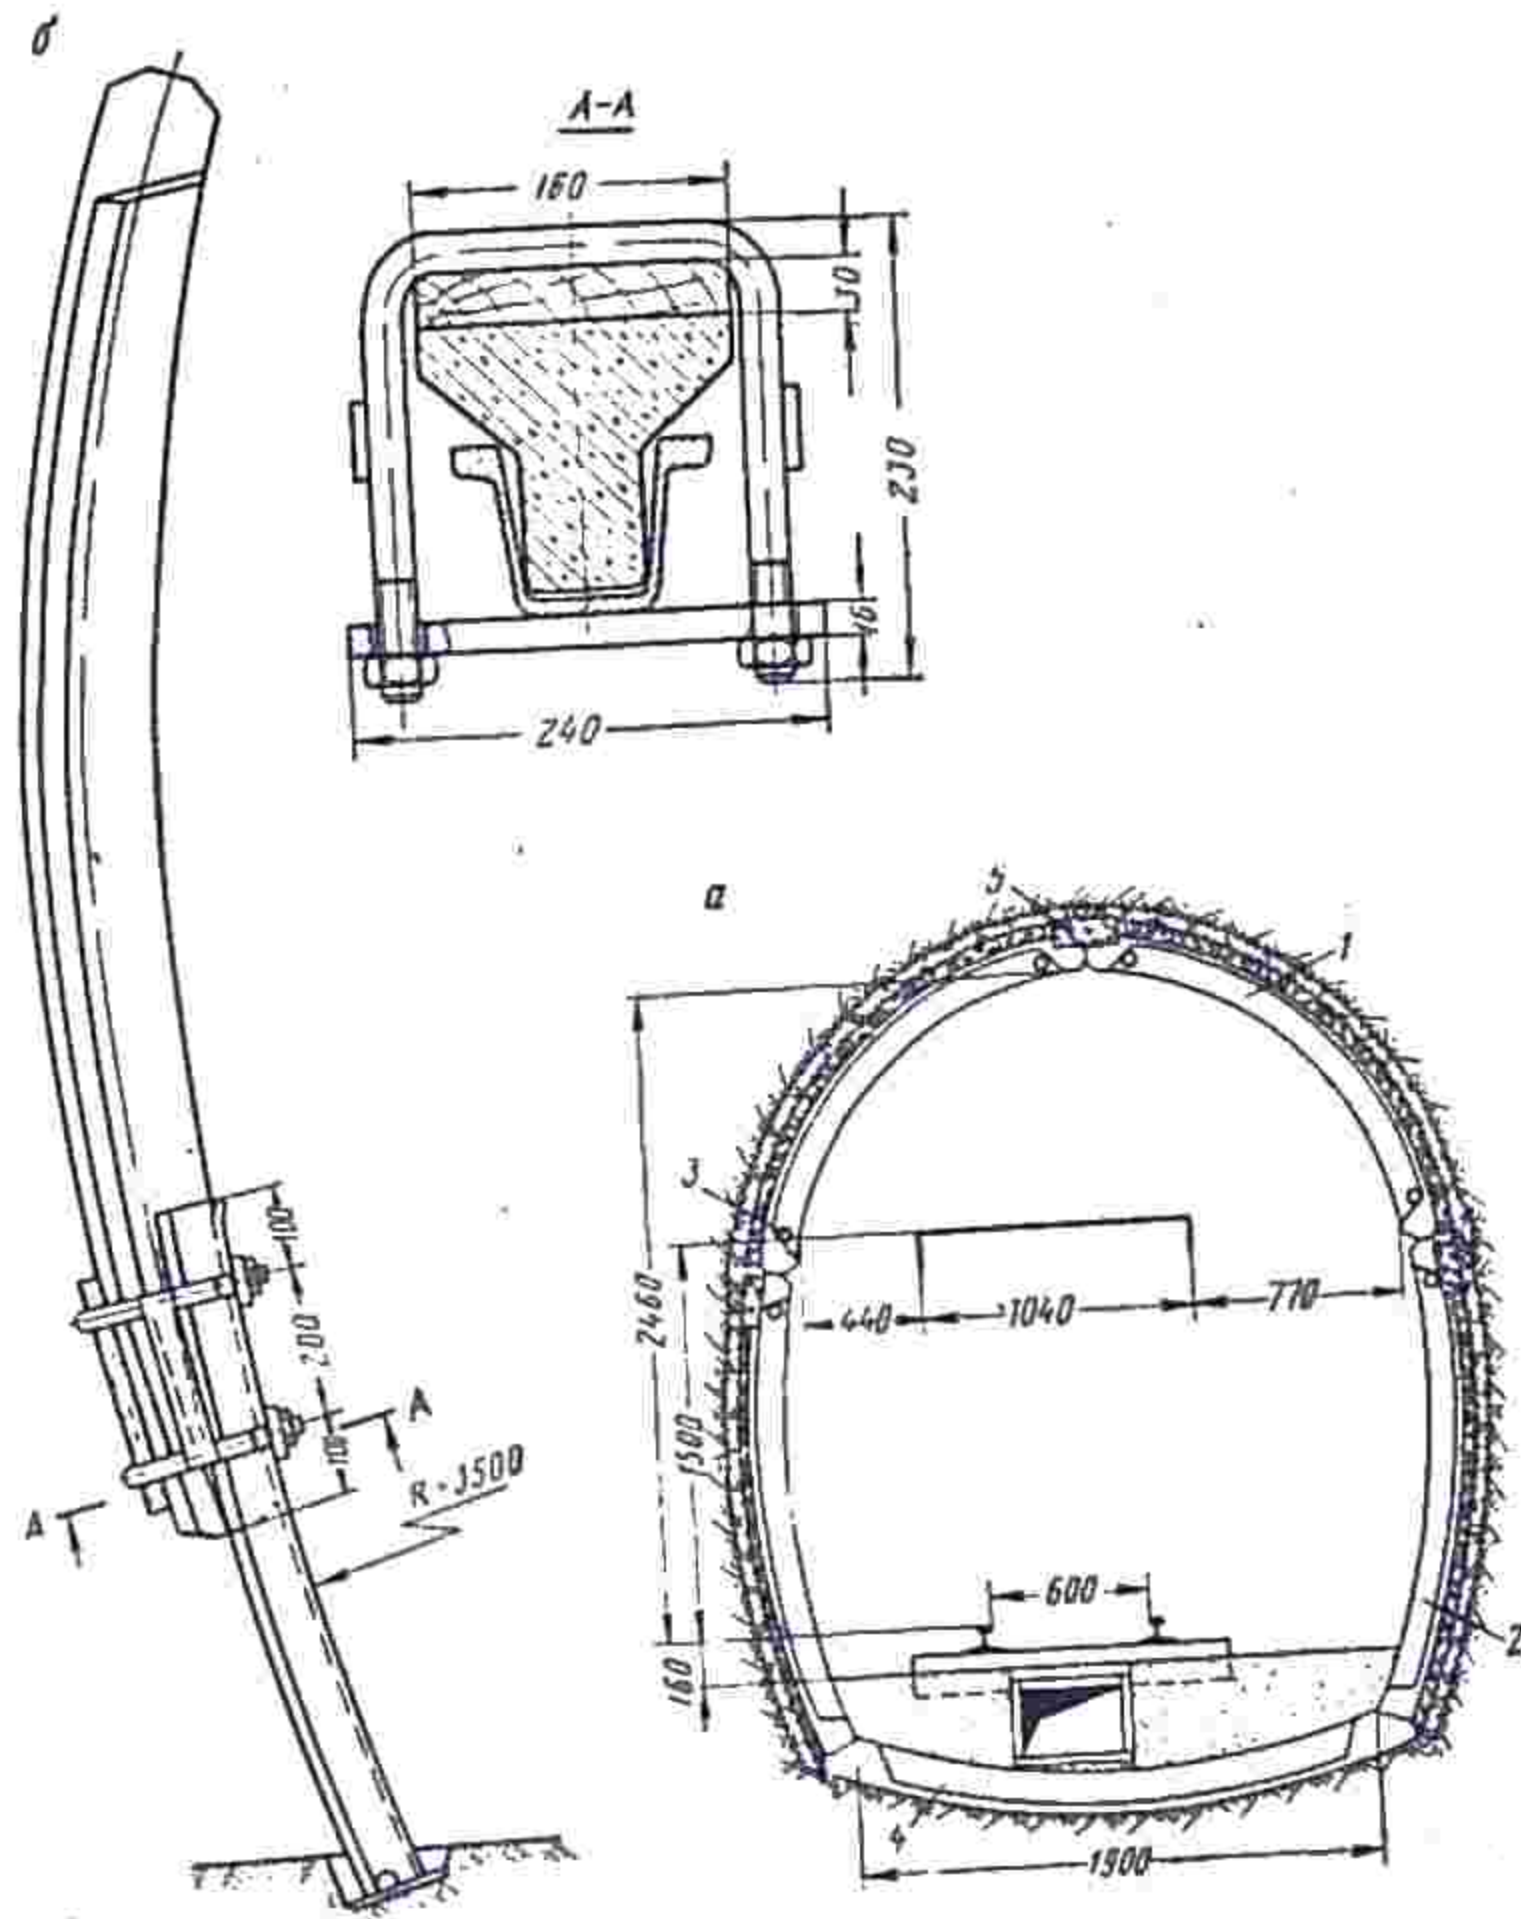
Железобетонная арочная шарнирная крепь: а — общий вид местной арки; б — опорный элемент податливой арки
